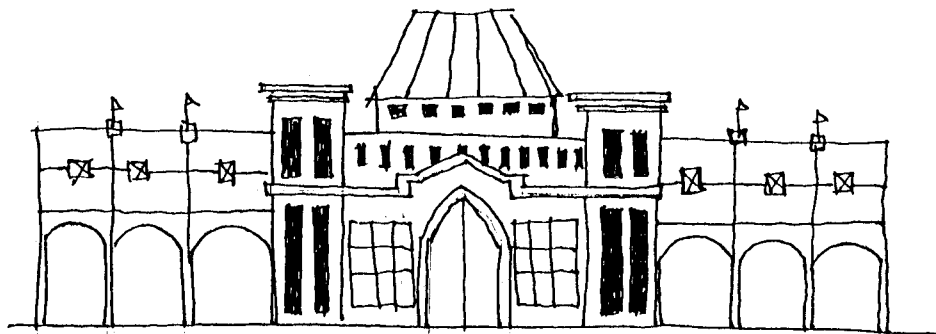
Studi Facade Bangunan Pasar Beringharjo
